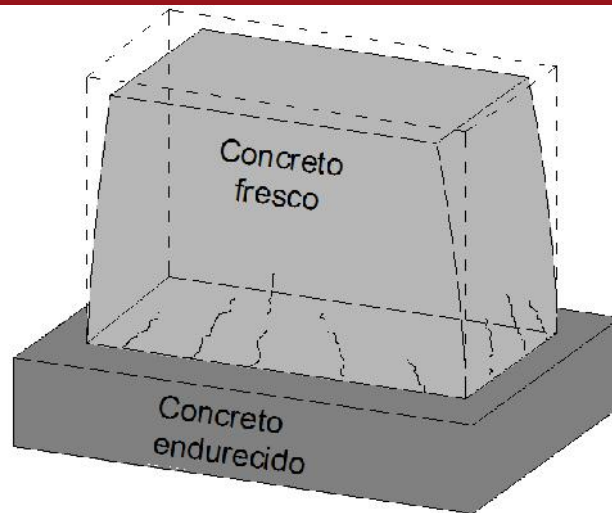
Grietas formadas por las restricciones externas
